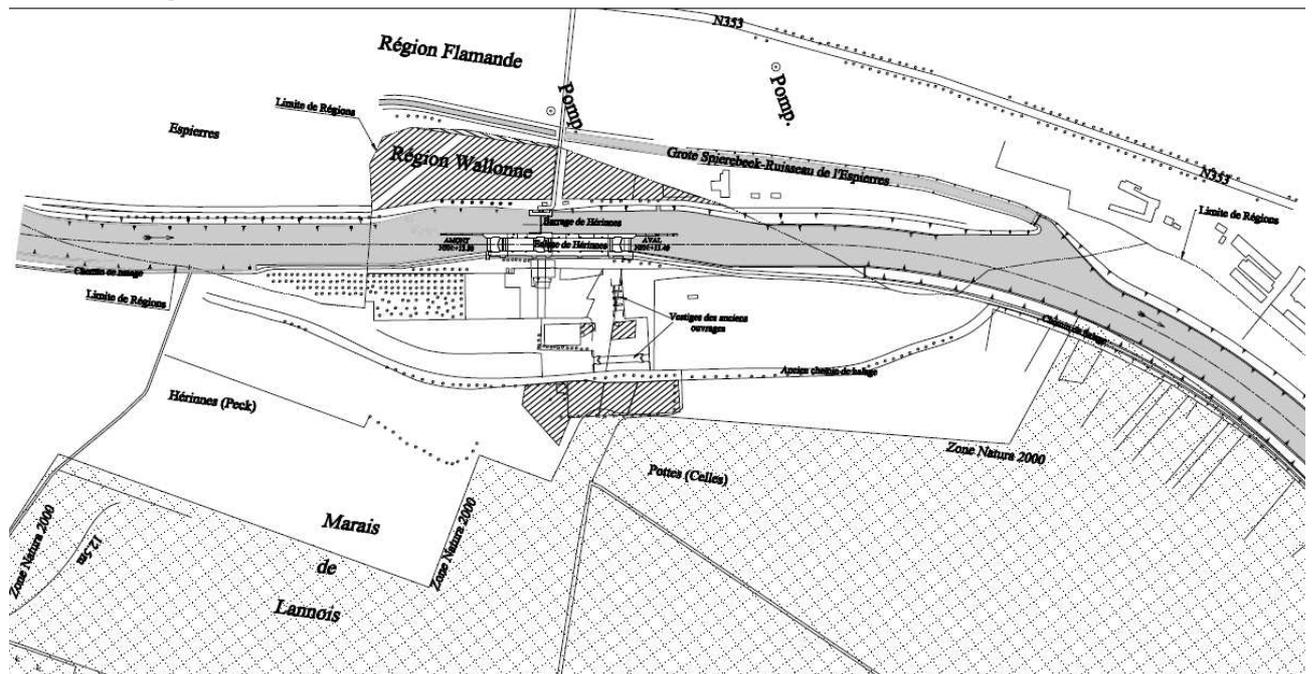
Site du barrage éclusé de Hérimnes, situation existante (source : SPW)
